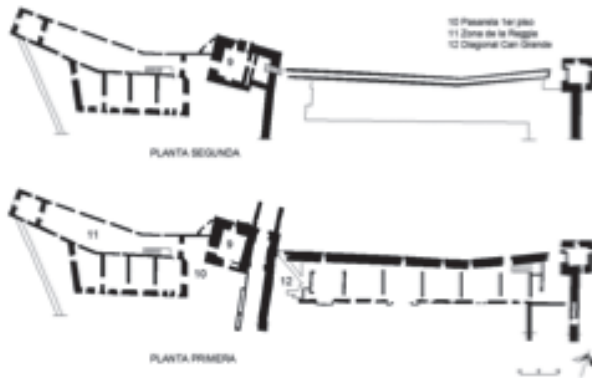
Planos, primera y segunda de Castelvecchio, elaboración propia.
